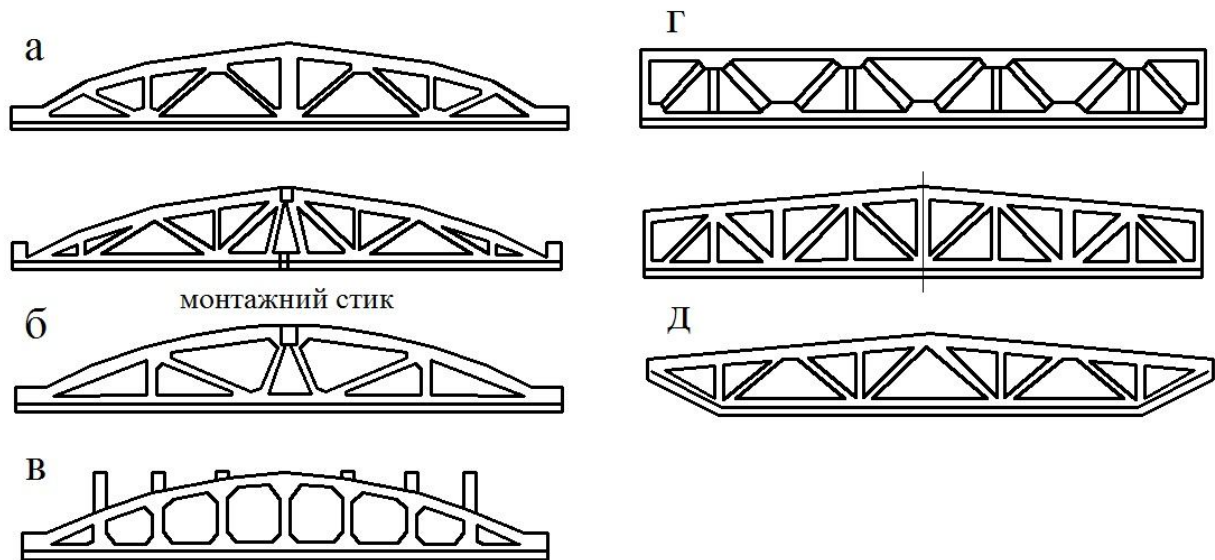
Конструктивні схеми залізобетонних ферм
